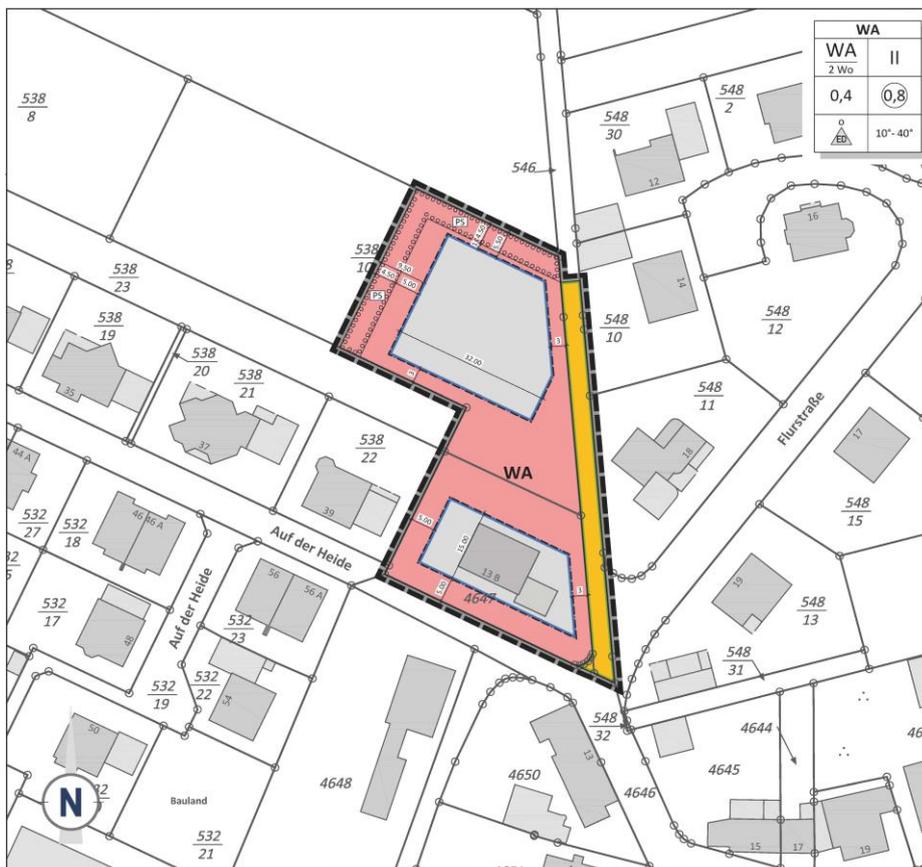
Bebauungsplan mit Nutzungsschablone
